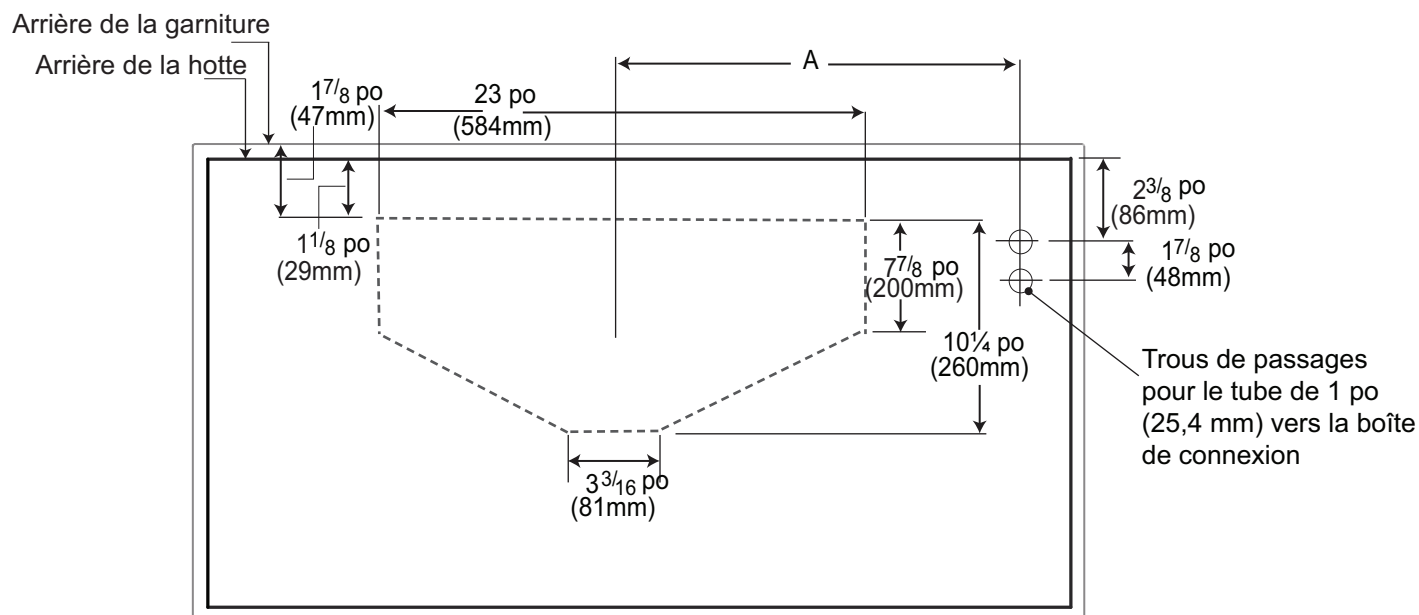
Dimensions des ouvertures pour le raccord et le tube
